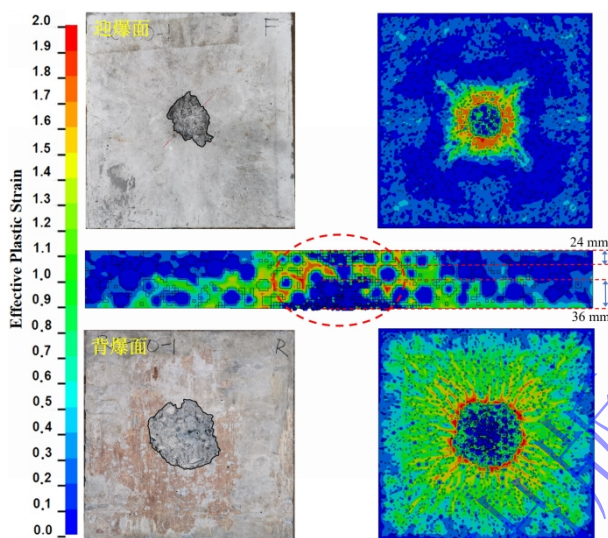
80 mm 钢筋混凝土板接触爆炸试验与模拟结果
